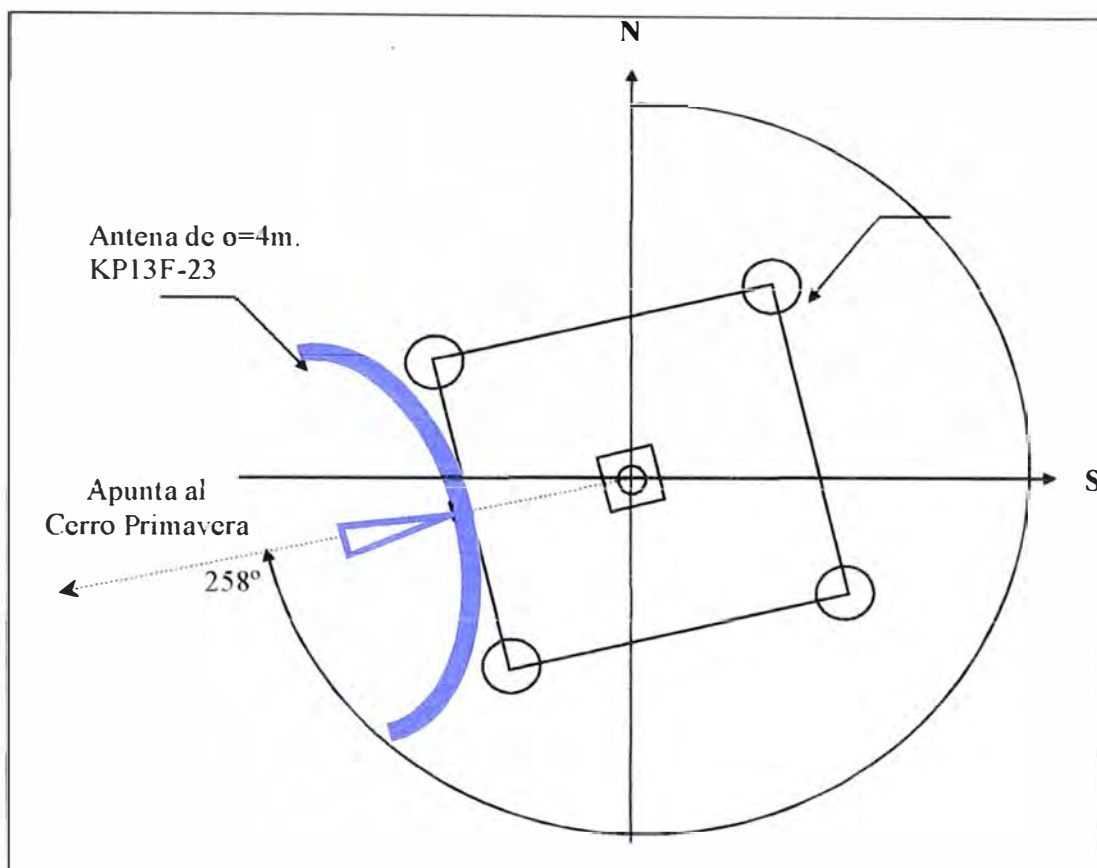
Vista de Planta de la Torre – C. H. Yanango
